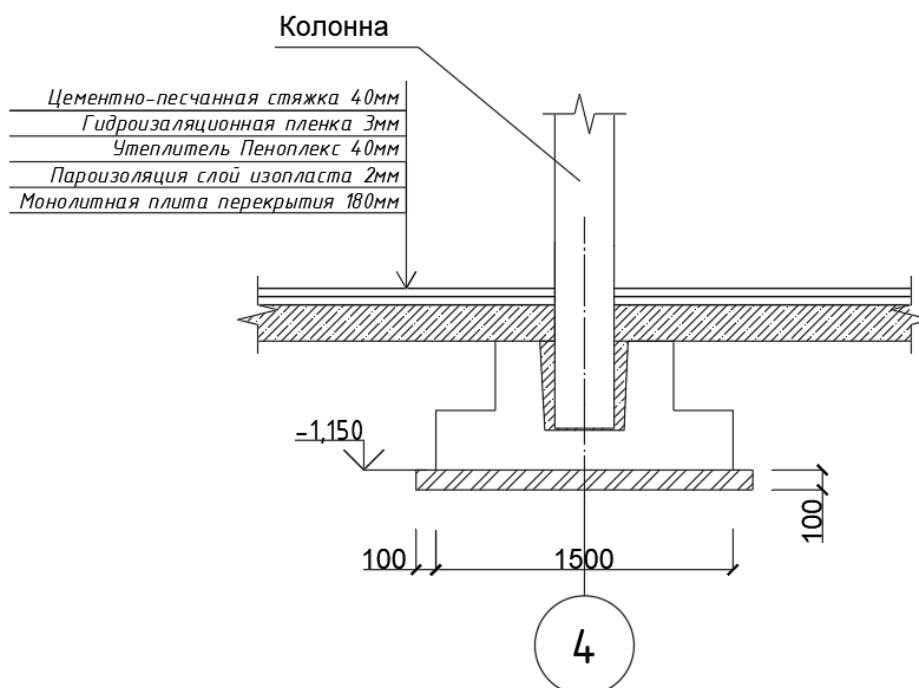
Сечение столбчатого фундамента Ф-1.
